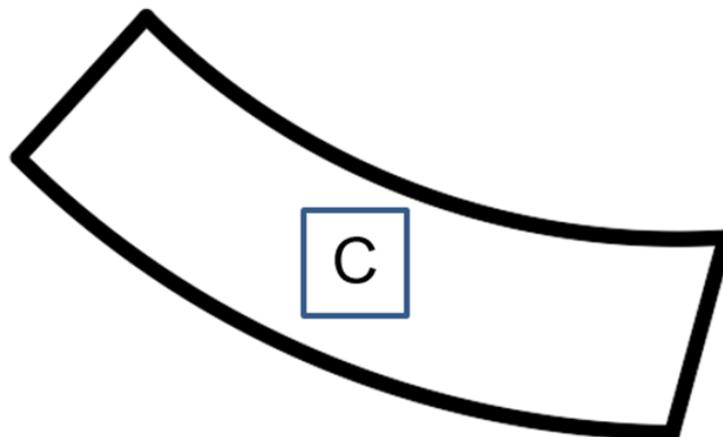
Plano conceptual de la Cuarta Planta. Fuente: Elaboración propia
